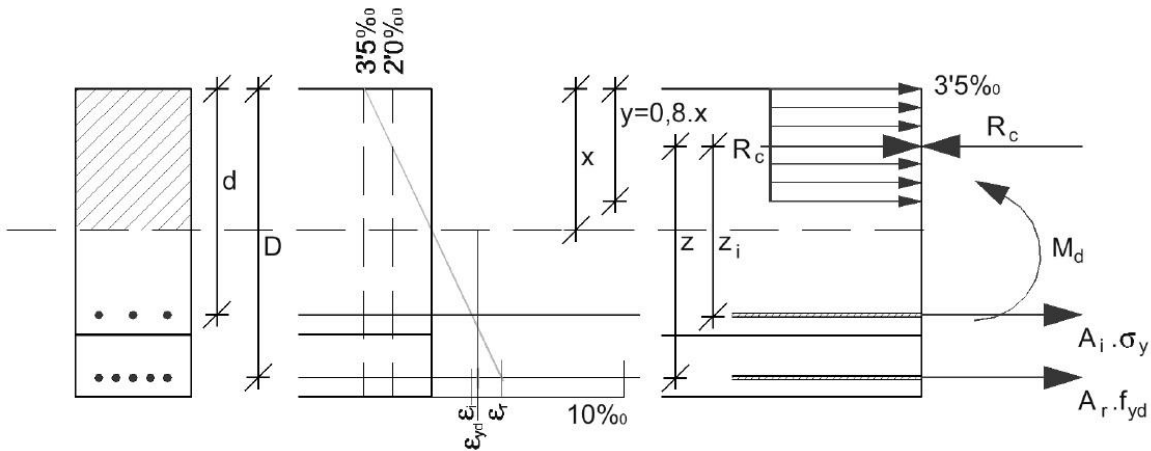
Cálculo del refuerzo de vigas a flexión con hormigón armado. Fuerzas y deformaciones en el hormigón y el acero. Diagrama Parábola rectángulo
